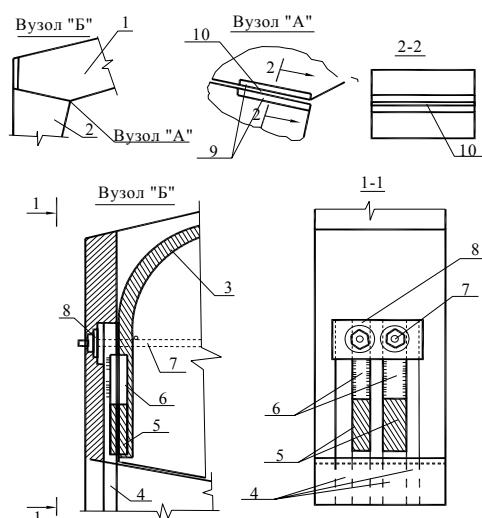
Безсварной узел соединения ригеля со стойкой:
